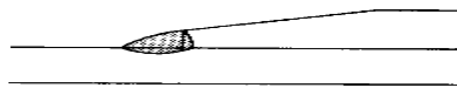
B Soldadura frontal en el extremo de una platabanda traccionada
